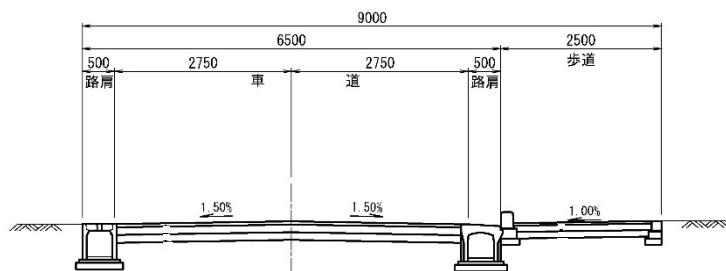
(4) 標準断面図 (区画道路 幅員 9.0m)
